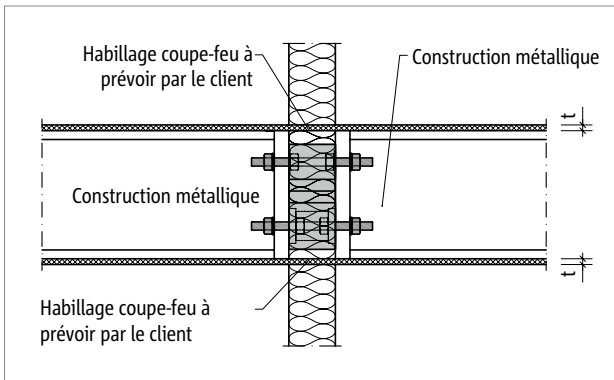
Protection incendie Schöck Isokorb® T type S : Bardage de protection incendie sur site pour plaques frontales affleurantes ; coupe
